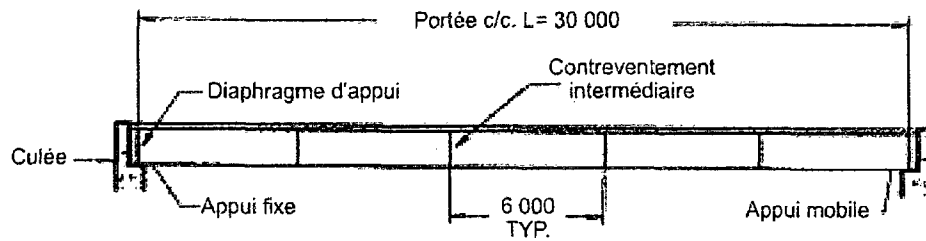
Coupe longitudinale du pont modèle à poutres d'acier (Moffatt 2001)
